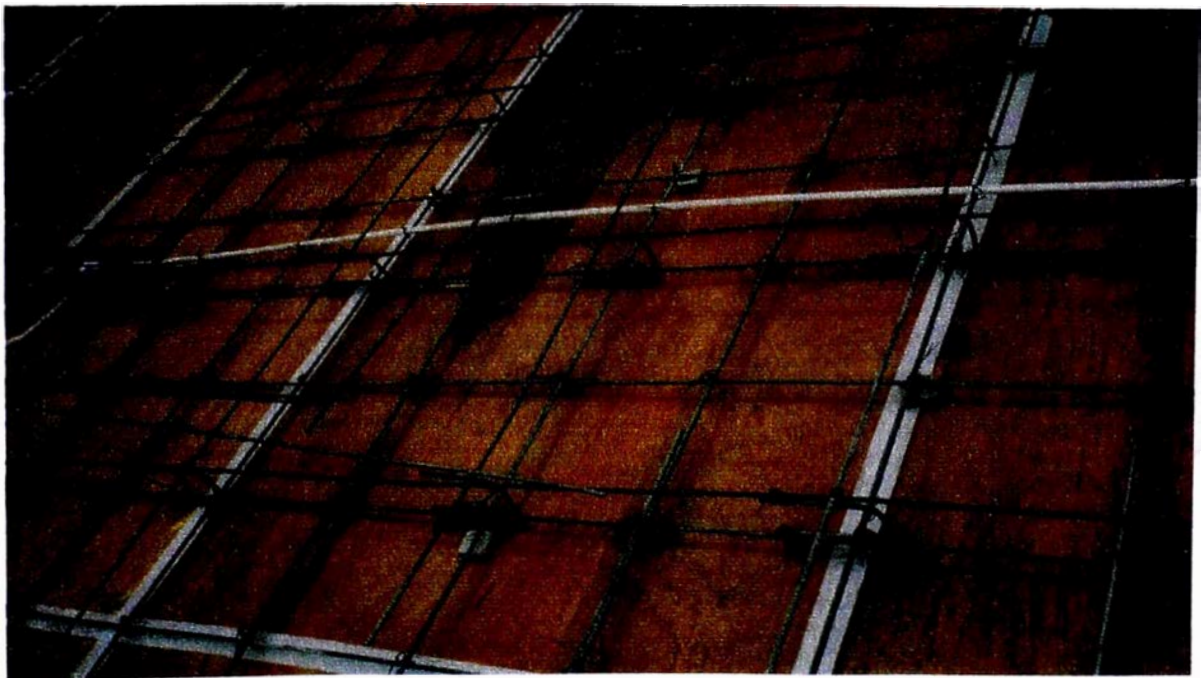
Refuerzos y tubos eléctricos en el encofrado la losa maciza de techo.
